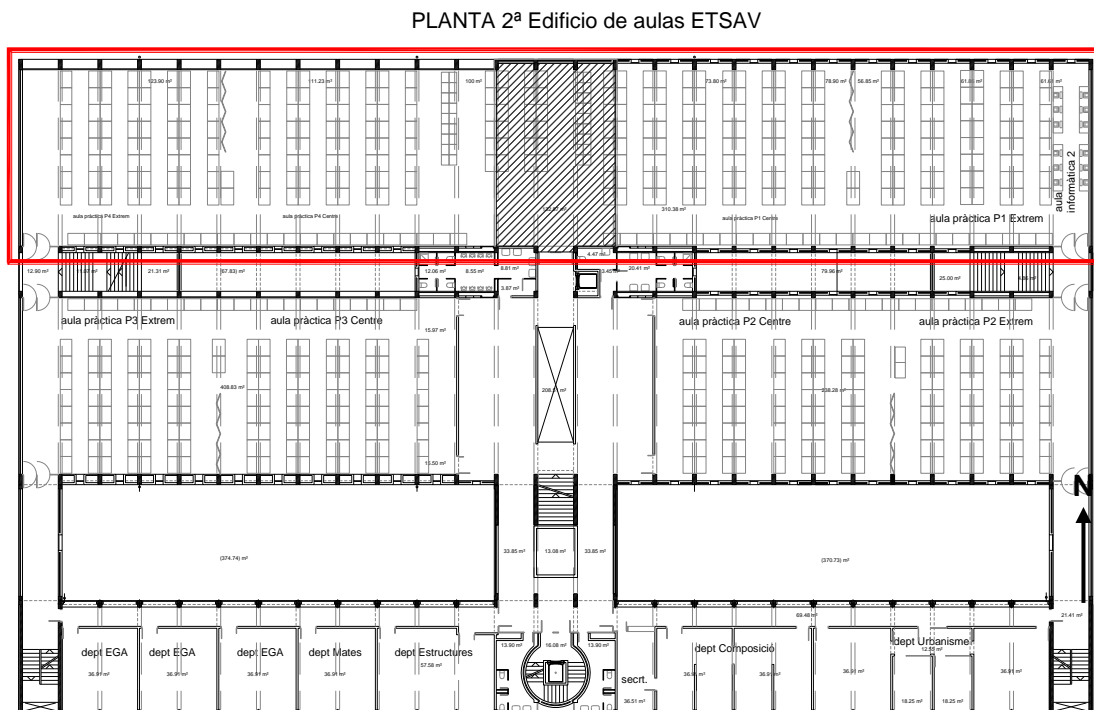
Planta 2ª edificio ETSAV (el área sombreada corresponde al sector de ensayo) (D')
